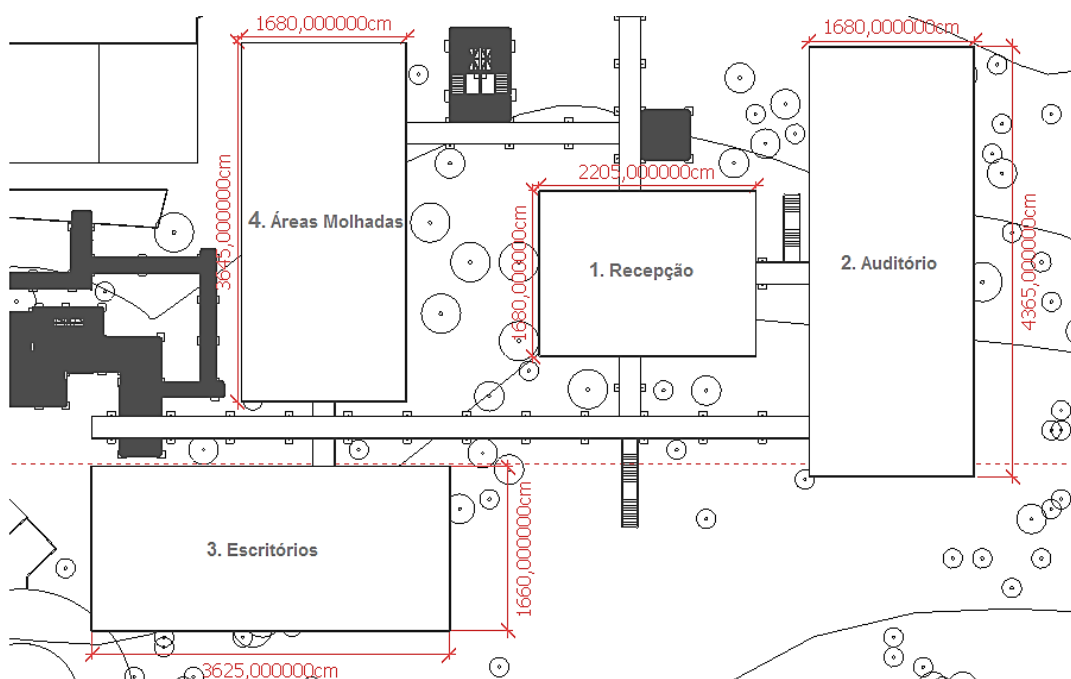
Planta baixa da cobertura dos quatro edifícios do PISAC.
